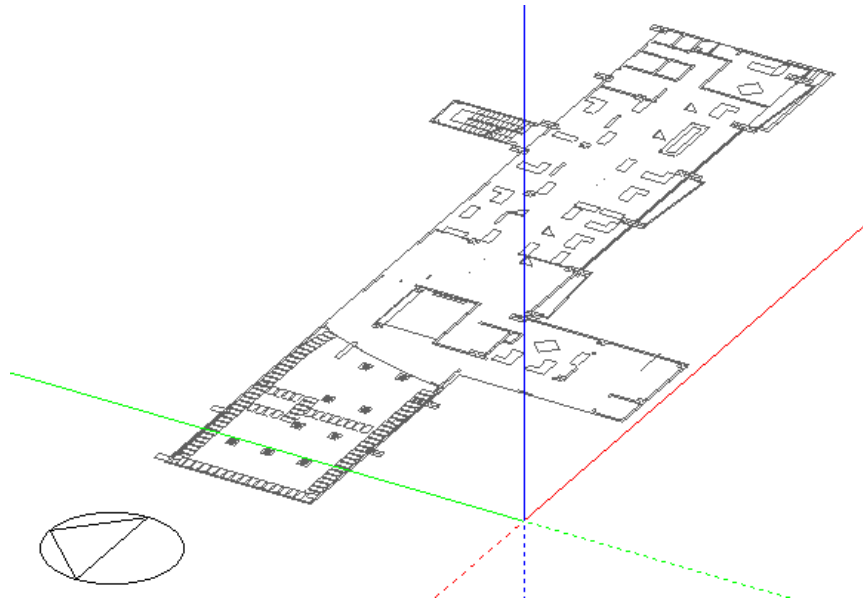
Plano CAD importado en *DesignBuilder*.
